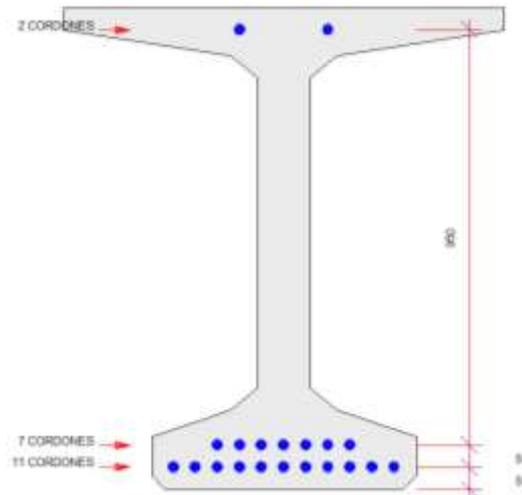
Armadura activa de las vigas de los tableros 2 y 3. Fuente: El. prop.
